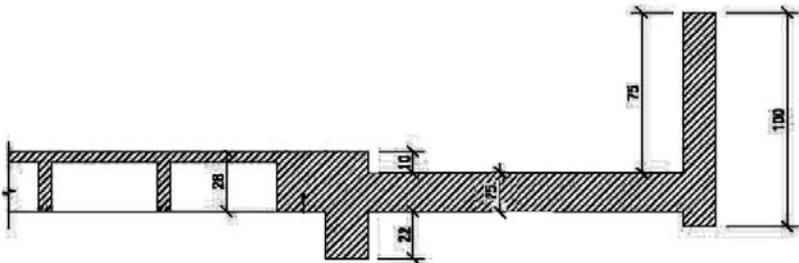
Corte da laje maciça da sacada e da laje nervurada dos apartamentos
